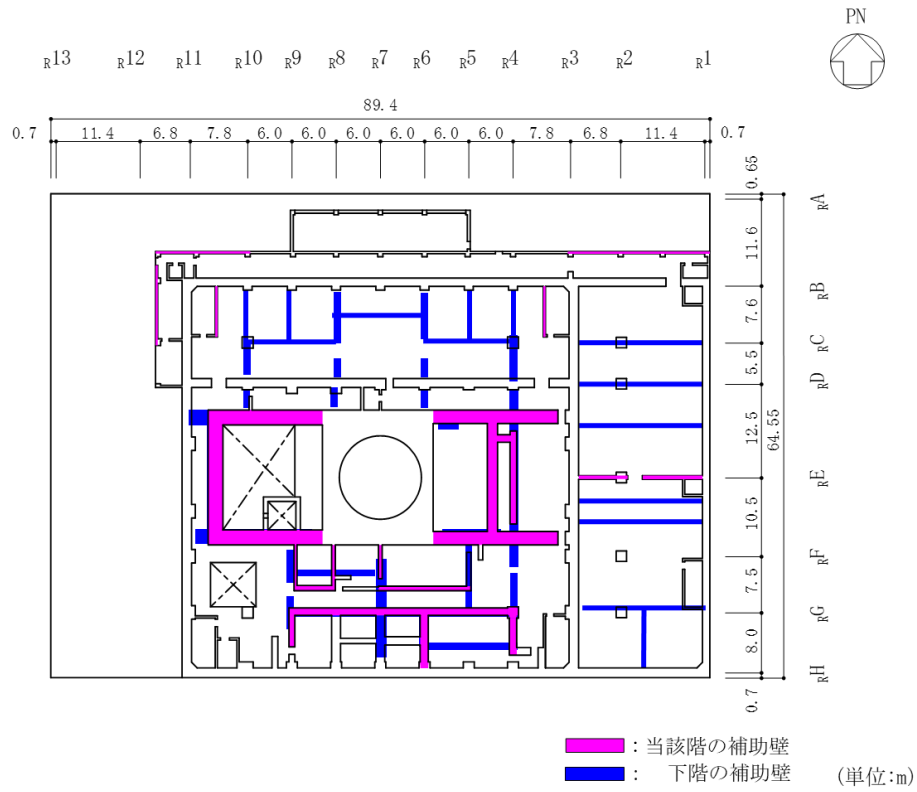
(5) 補助壁の配置図 (EL 34.8m)
